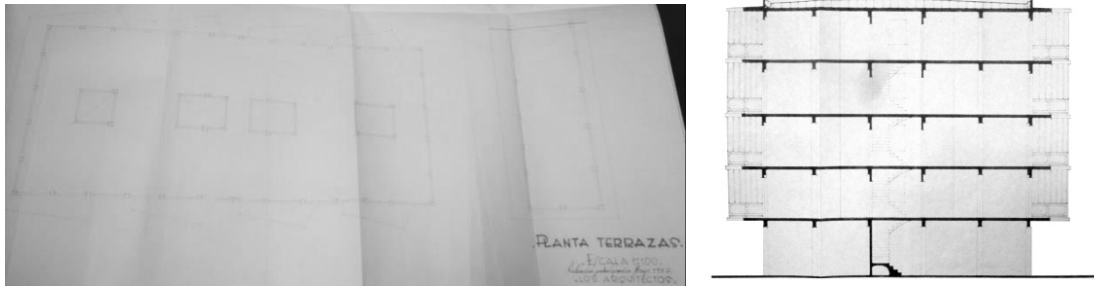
Planos originales de cubiertas del bloque X y sección transversal del bloque X. Fuente AMAG
